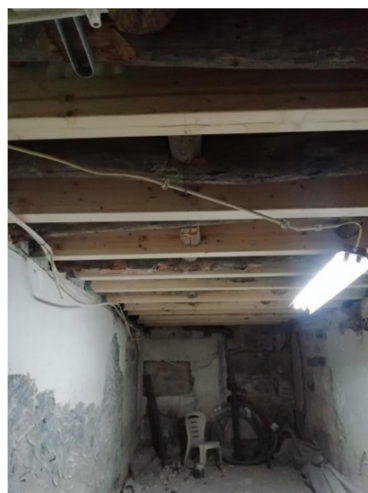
Intercalação das vigas existentes com vigas novas, perspetiva da cave
